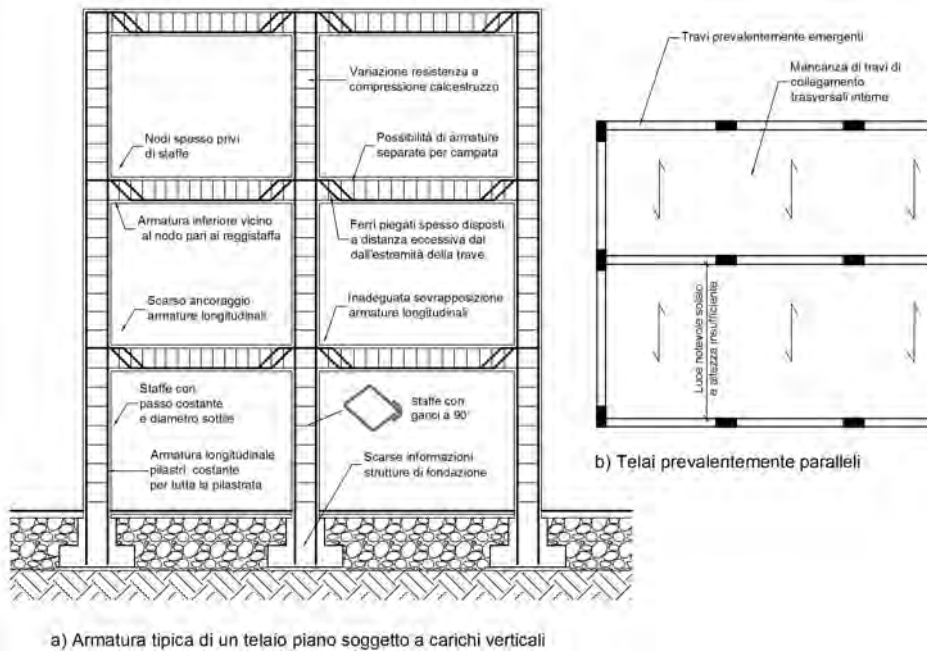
Armatura tipica di un telaio piano di un edificio esistente soggetto a carichi verticali
